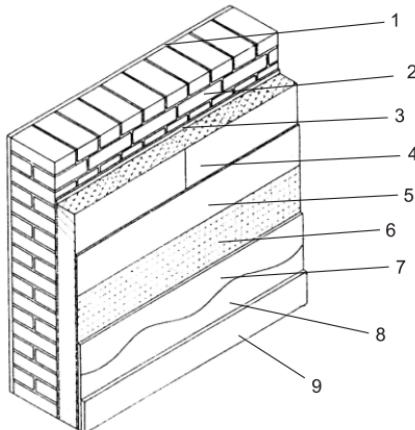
Схема системы утепления Ceresit WM: 1 — внутренняя штукатурка; 2 — наружная стена здания; 3 — раствор Ceresit CT 190 (ок. 6 кг/м²); 4 — плита из минераловатного утеплителя; 5 — раствор Ceresit CT 190 (ок. 3 кг/м²); 6 — сетка из стекловолокна (ок. 1,1 кг/м²); 7 — раствор Ceresit CT 190 (ок. 2 кг/м²); 8 — грунтовка Ceresit CT 16 (ок. 0,3 л/м²); 9 — декоративная отделка Ceresit
